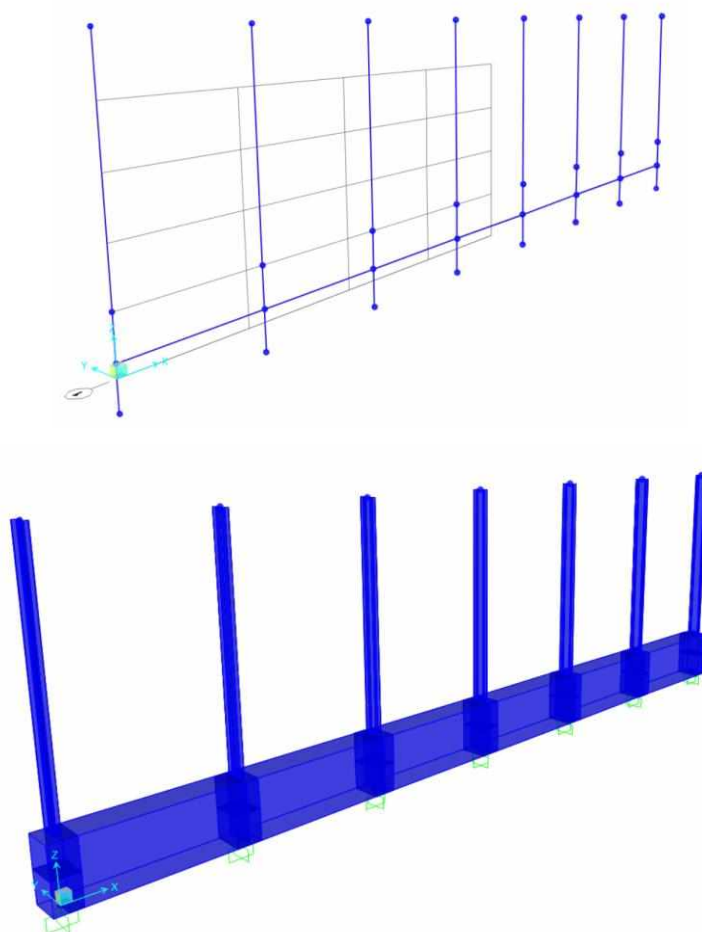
Modello di calcolo muro FOA TIPO 5 con elementi beam
